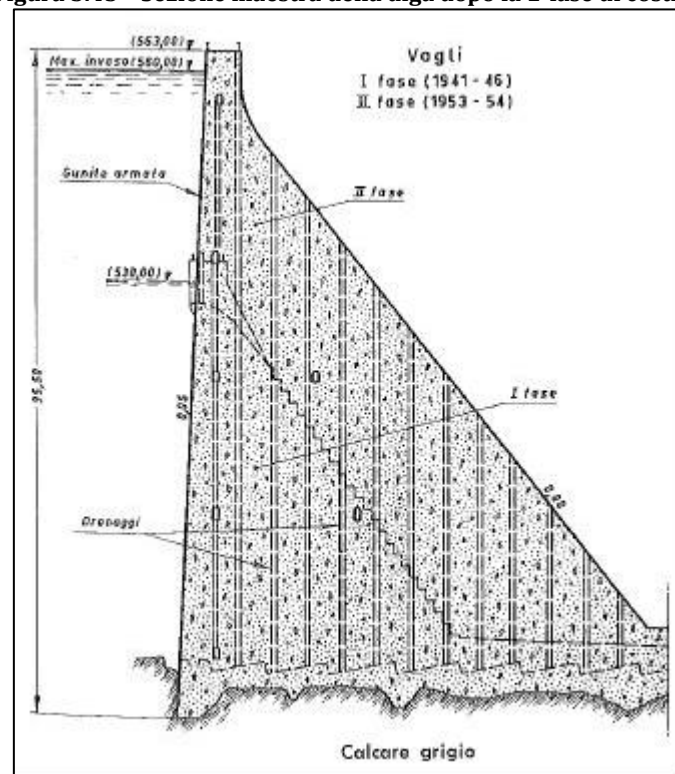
Sezione maestra della diga dopo la 2ª fase di costruzione
